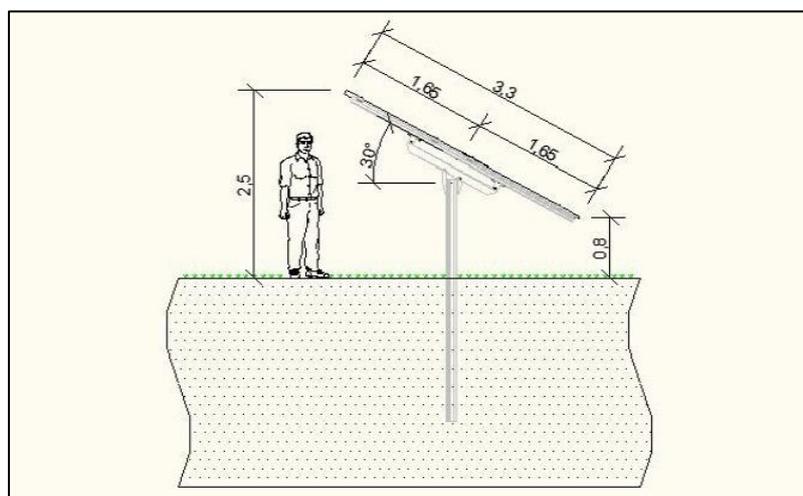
Schéma de construction type (Source : document interne à l'entreprise)
